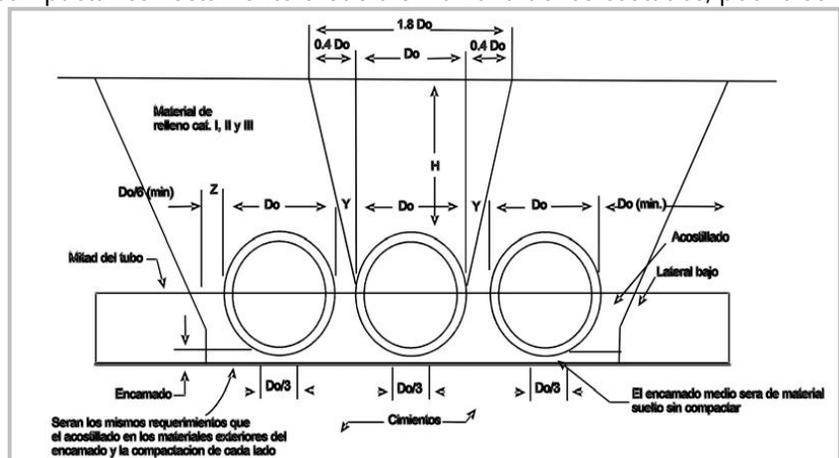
Colocación de tres tuberías en zanja amplia
